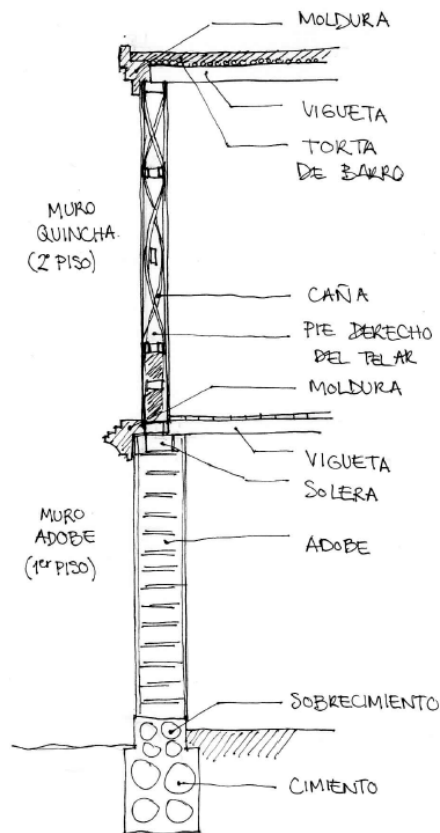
Detalle constructivo de la fachada. Fuente: M. Rosario Velasco García.
